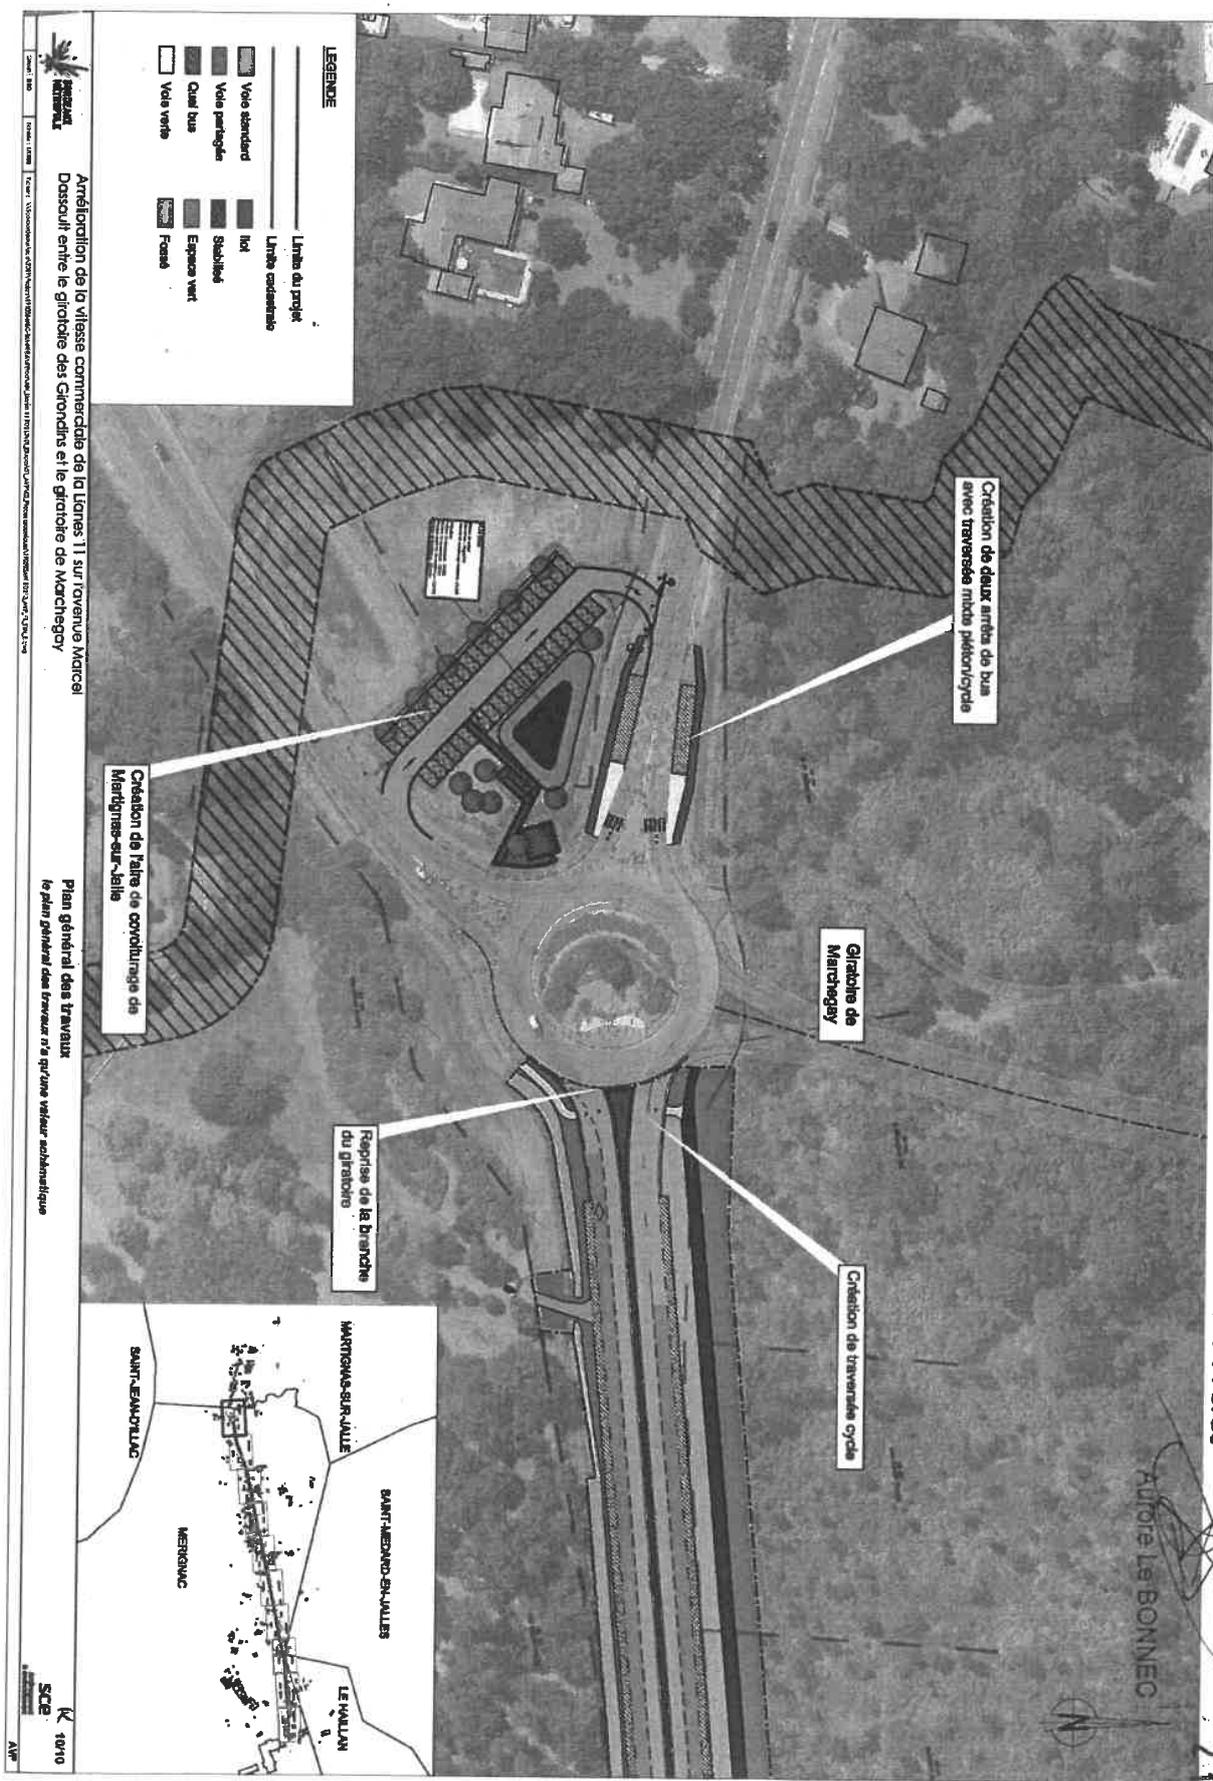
Plan Général des Travaux - Localisation des zooms de tronçon. Source : Bordeaux Métropole
